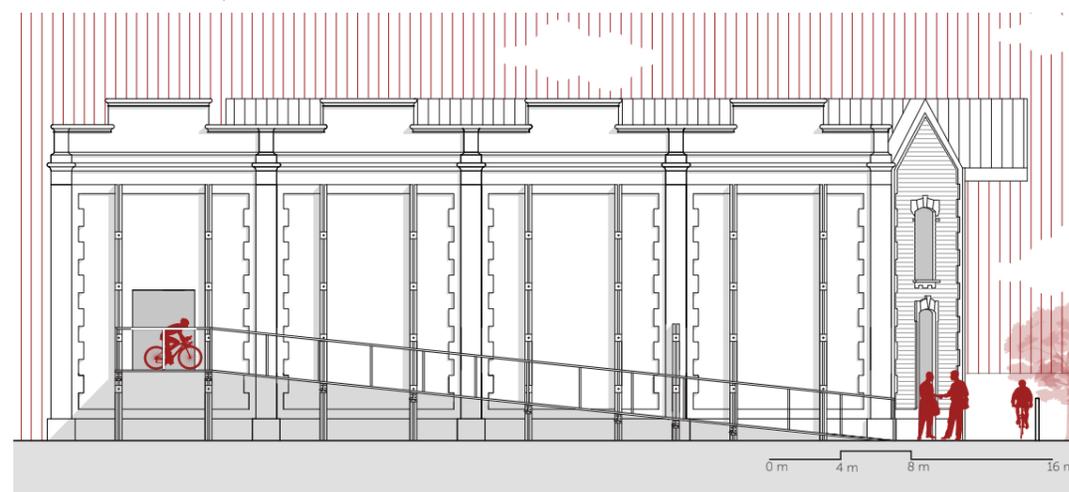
Prospetto ovest - scala di dettaglio 1:100
